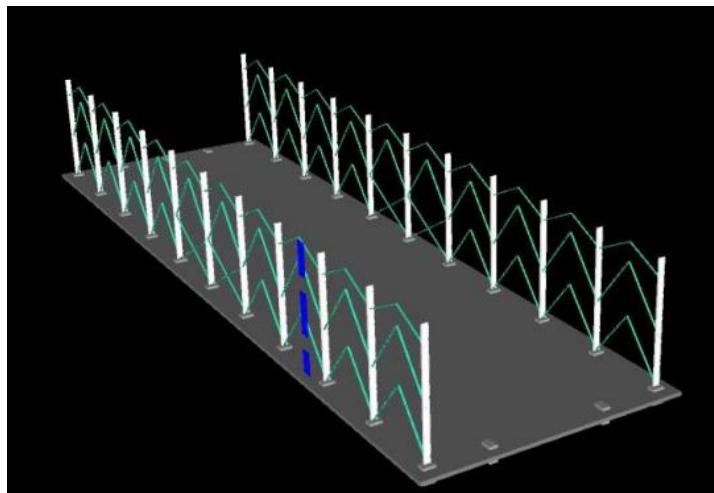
Montaje de columnas y diagonales verticales ejes A y B
